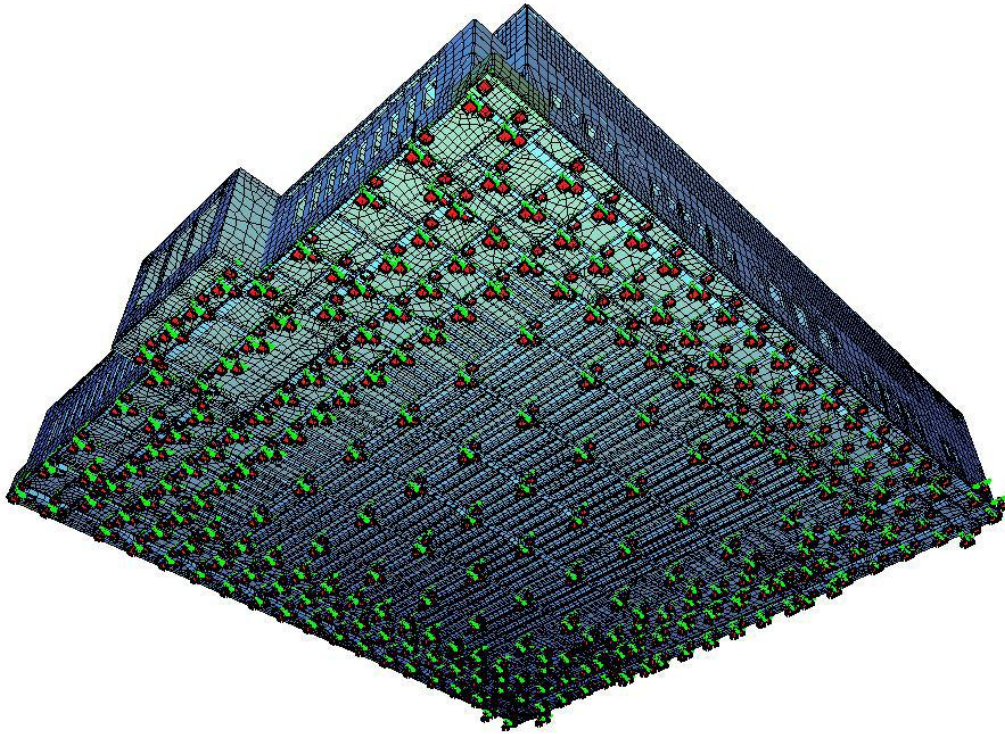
modèle d'ensemble en 3D – vue de dessous avec définition d'appui
